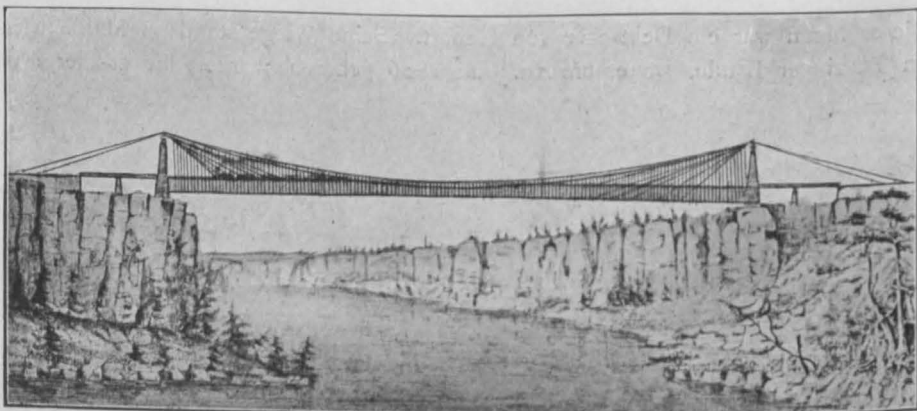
Niagara-Eisenbahn- und Straßenbrücke. 1855.
